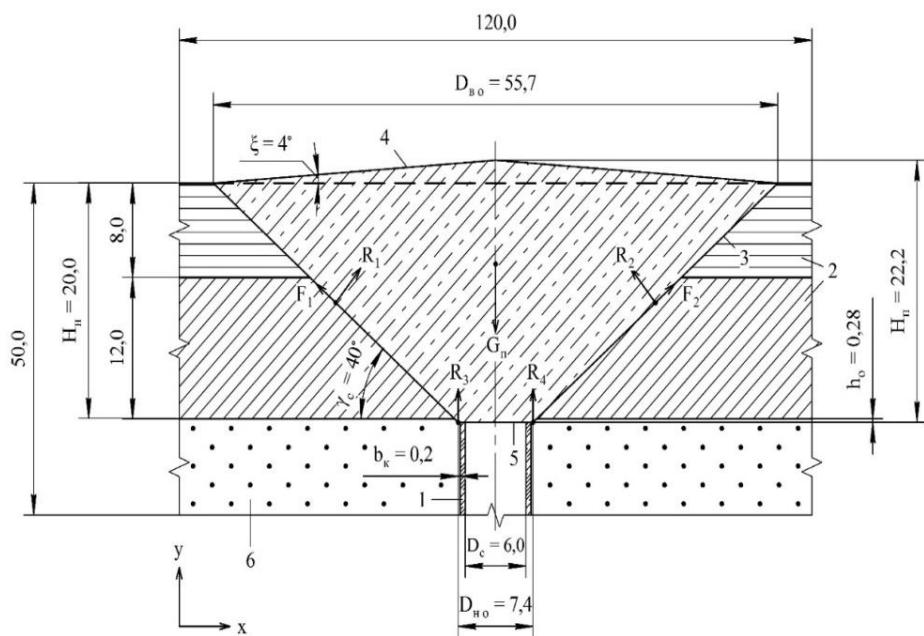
Модель взаимодействия конусообразного распорного монолитного изолирующего перекрытия ликвидируемого вертикального ствола с наносами: 1 – крепь ствола; 2 – наносы; 3 – контур распорного монолитного перекрытия; 4 и 5 – верхнее и нижнее основания распорного перекрытия; 6 – коренные породы (размеры в метрах)
